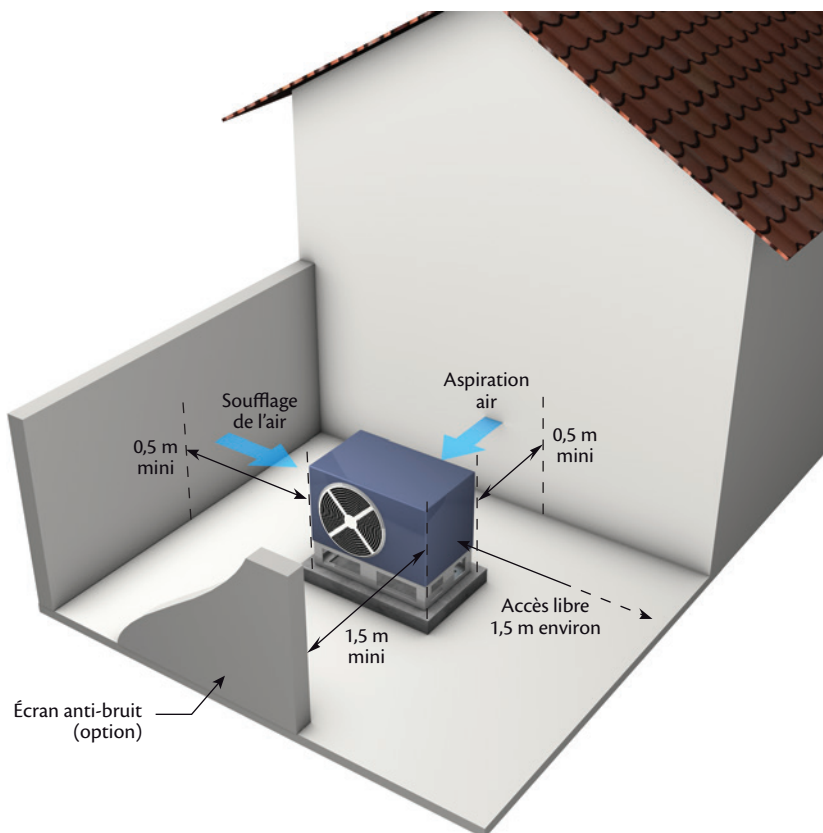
Exemple d'implantation d'une pompe à chaleur et d'un écran antibruit
